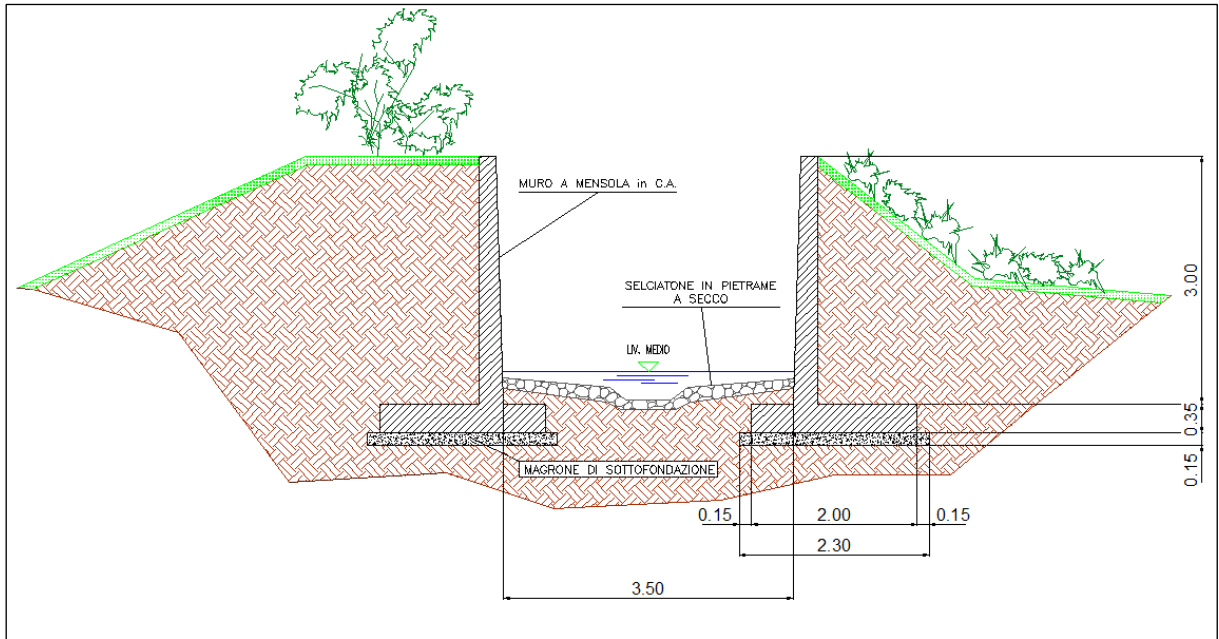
Sezione tipo del canale con sponde in cemento armato previsto per la terza soluzione progettuale
